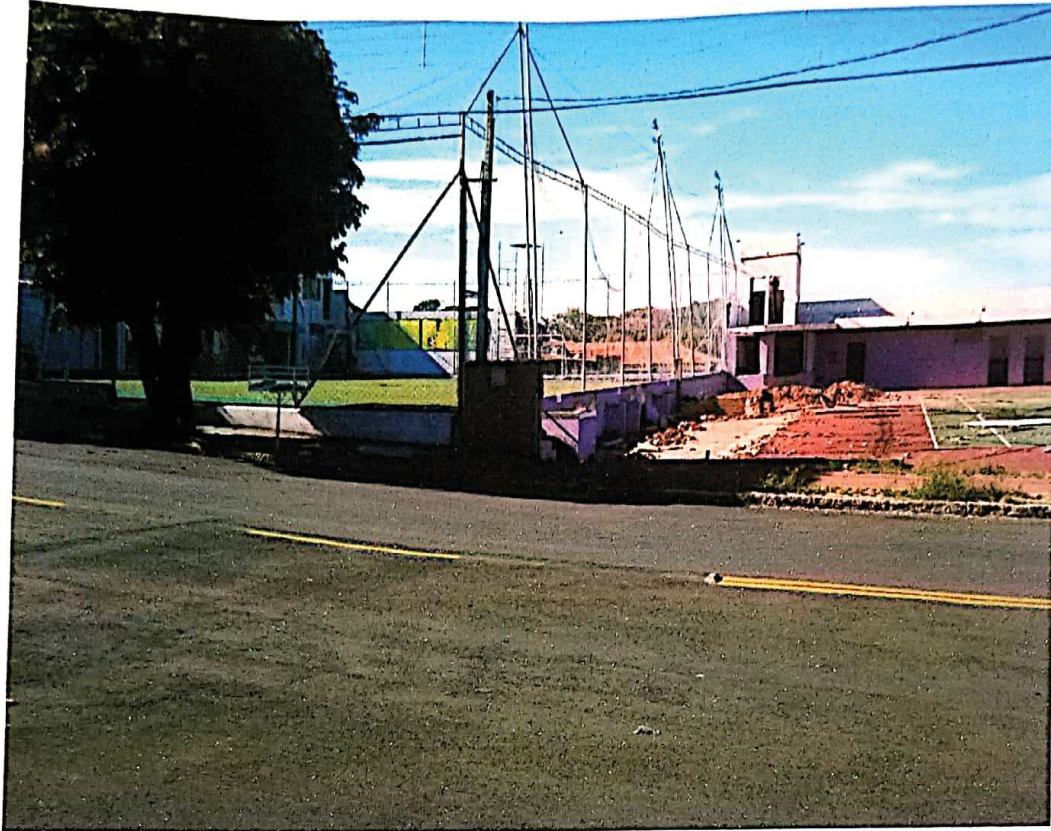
DIVISA COM ACADEMIA – INSTALAÇÕES DESTRUÍDAS
